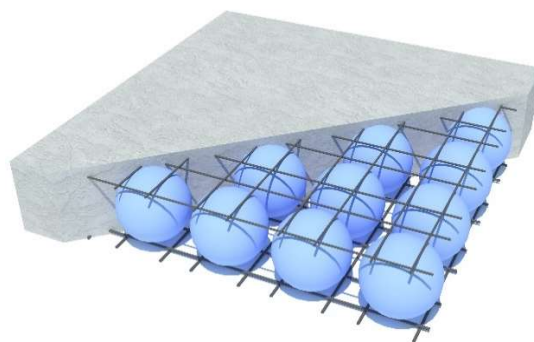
Sistemas construtivos de lajes *BubbleDeck
